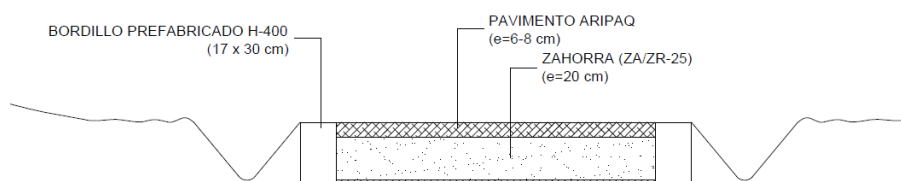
Sección tipo de senda de 1,5 metros de anchura
